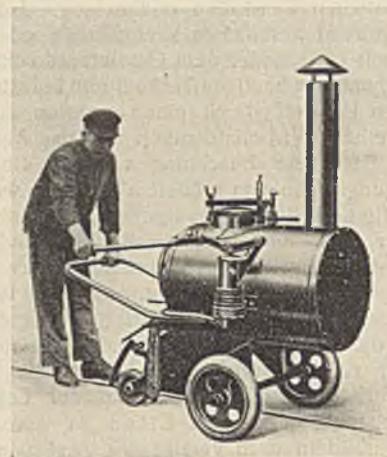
Fugengießgerät für bituminöse Straßendecken.
